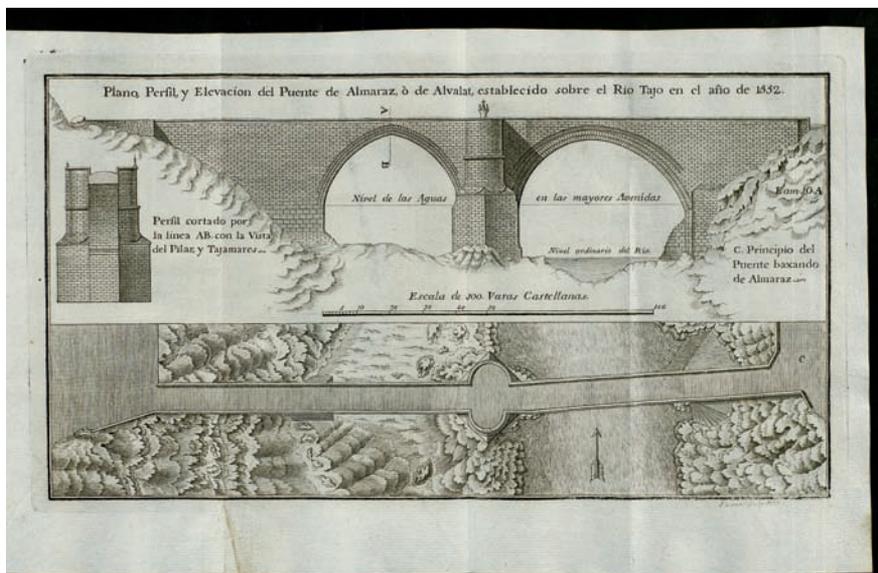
Plano del tratado de John Muller del puente de Almaraz. Biblioteca de la Fundación Juanelo Turriano.
